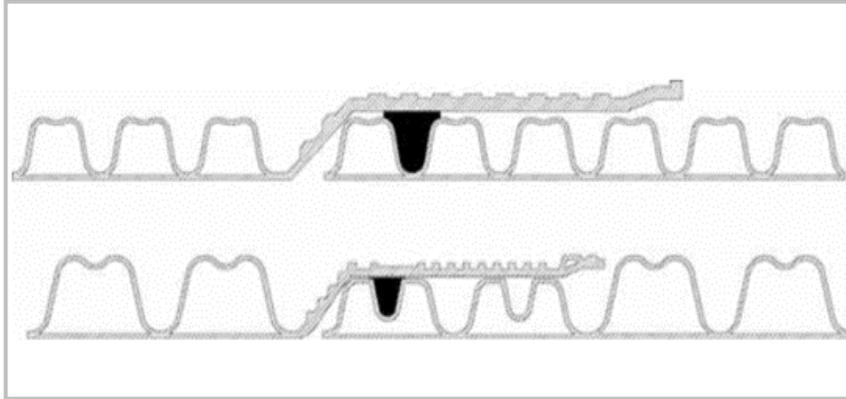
Sistema de unión espiga-campana de tuberías corrugadas
